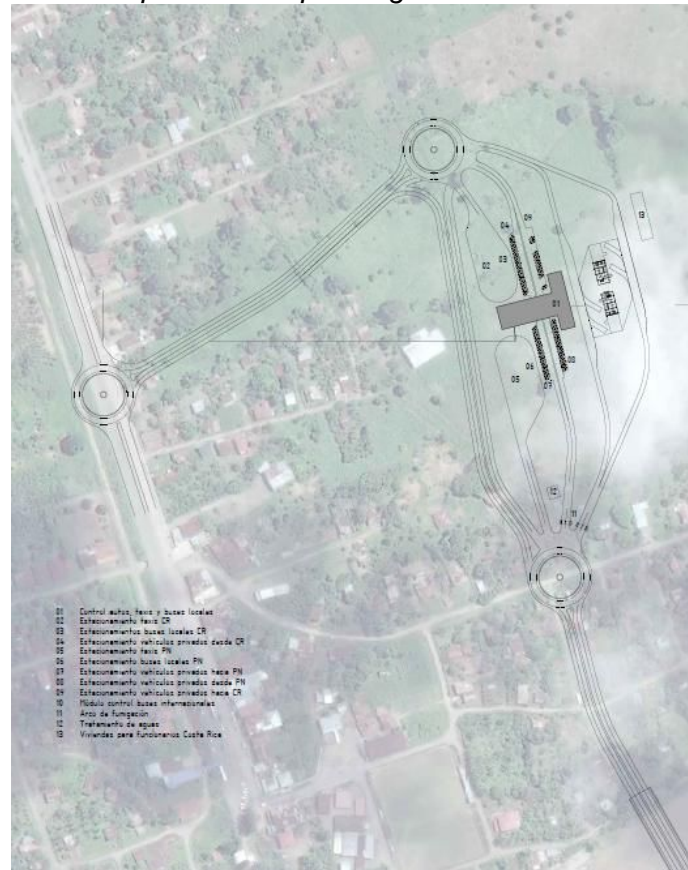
Esquema de la planta general – Alternativa 3 (PA)
